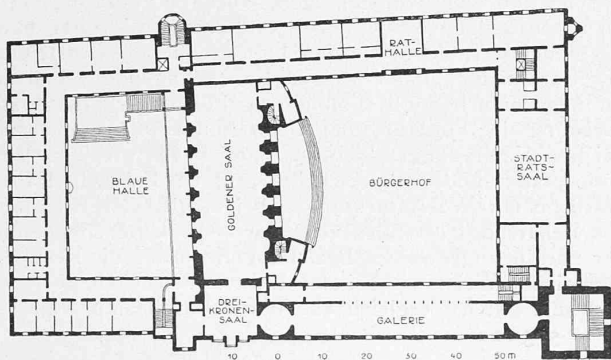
Grundriss vom I. Stock. — Masstab 1 : 1500.
